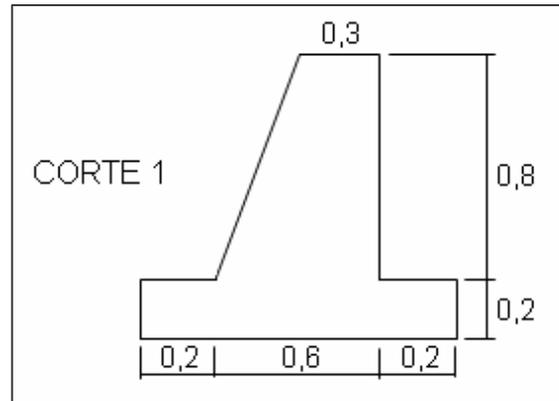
Dimensiones de muro en concreto ciclópeo.
